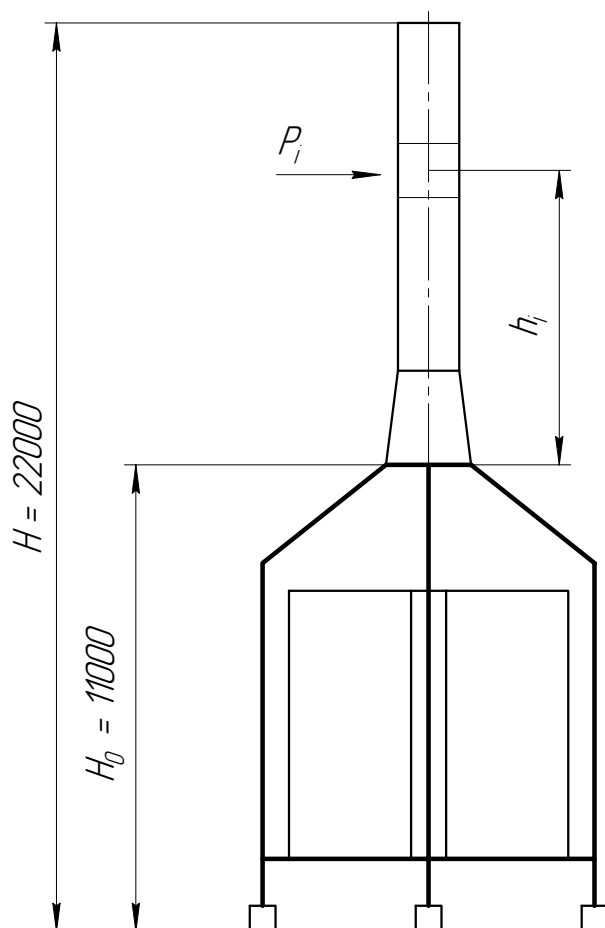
Схема к расчету трубы на ветровую нагрузку
